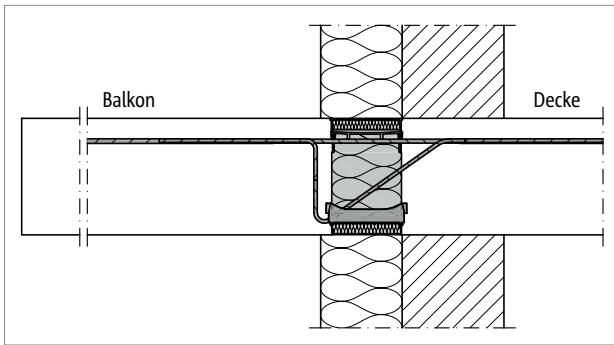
Schöck Isokorb® XT Typ KL: Anschluss bei Wärmedämmverbundsystem (WDVS)
